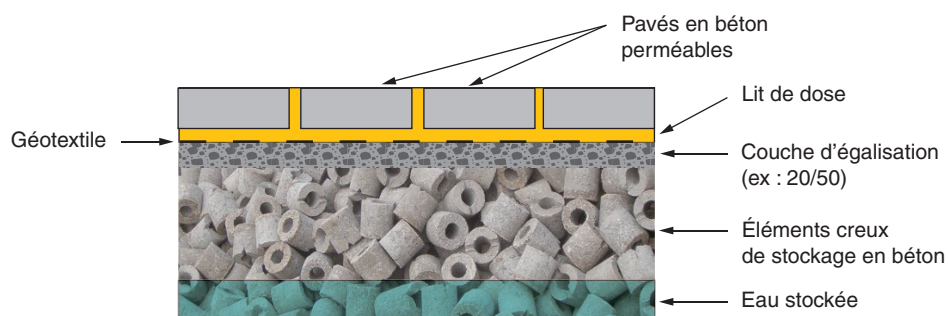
Revêtement et structure réservoir en produits préfabriqués en béton
